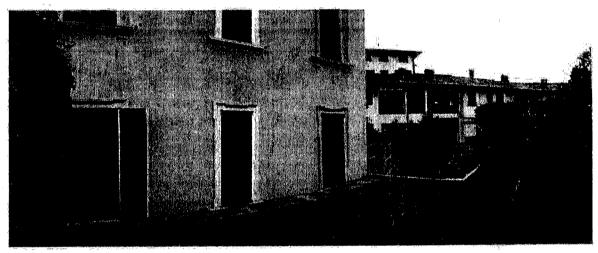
, 10 e 11 - Rilievo esterno - Panoramica dell'area esterna piantumata ad Ovest del fabbricato e dell'autorimessa interrata costruita in aderenza sia al fabbricato che al confine Ovest del lotto (rilevata difformità catastale e progettuale).
